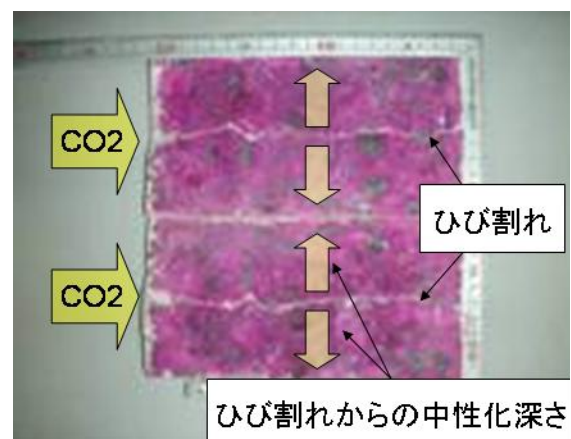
ひび割れ面内部の中性化の様子 BS 5%促進
